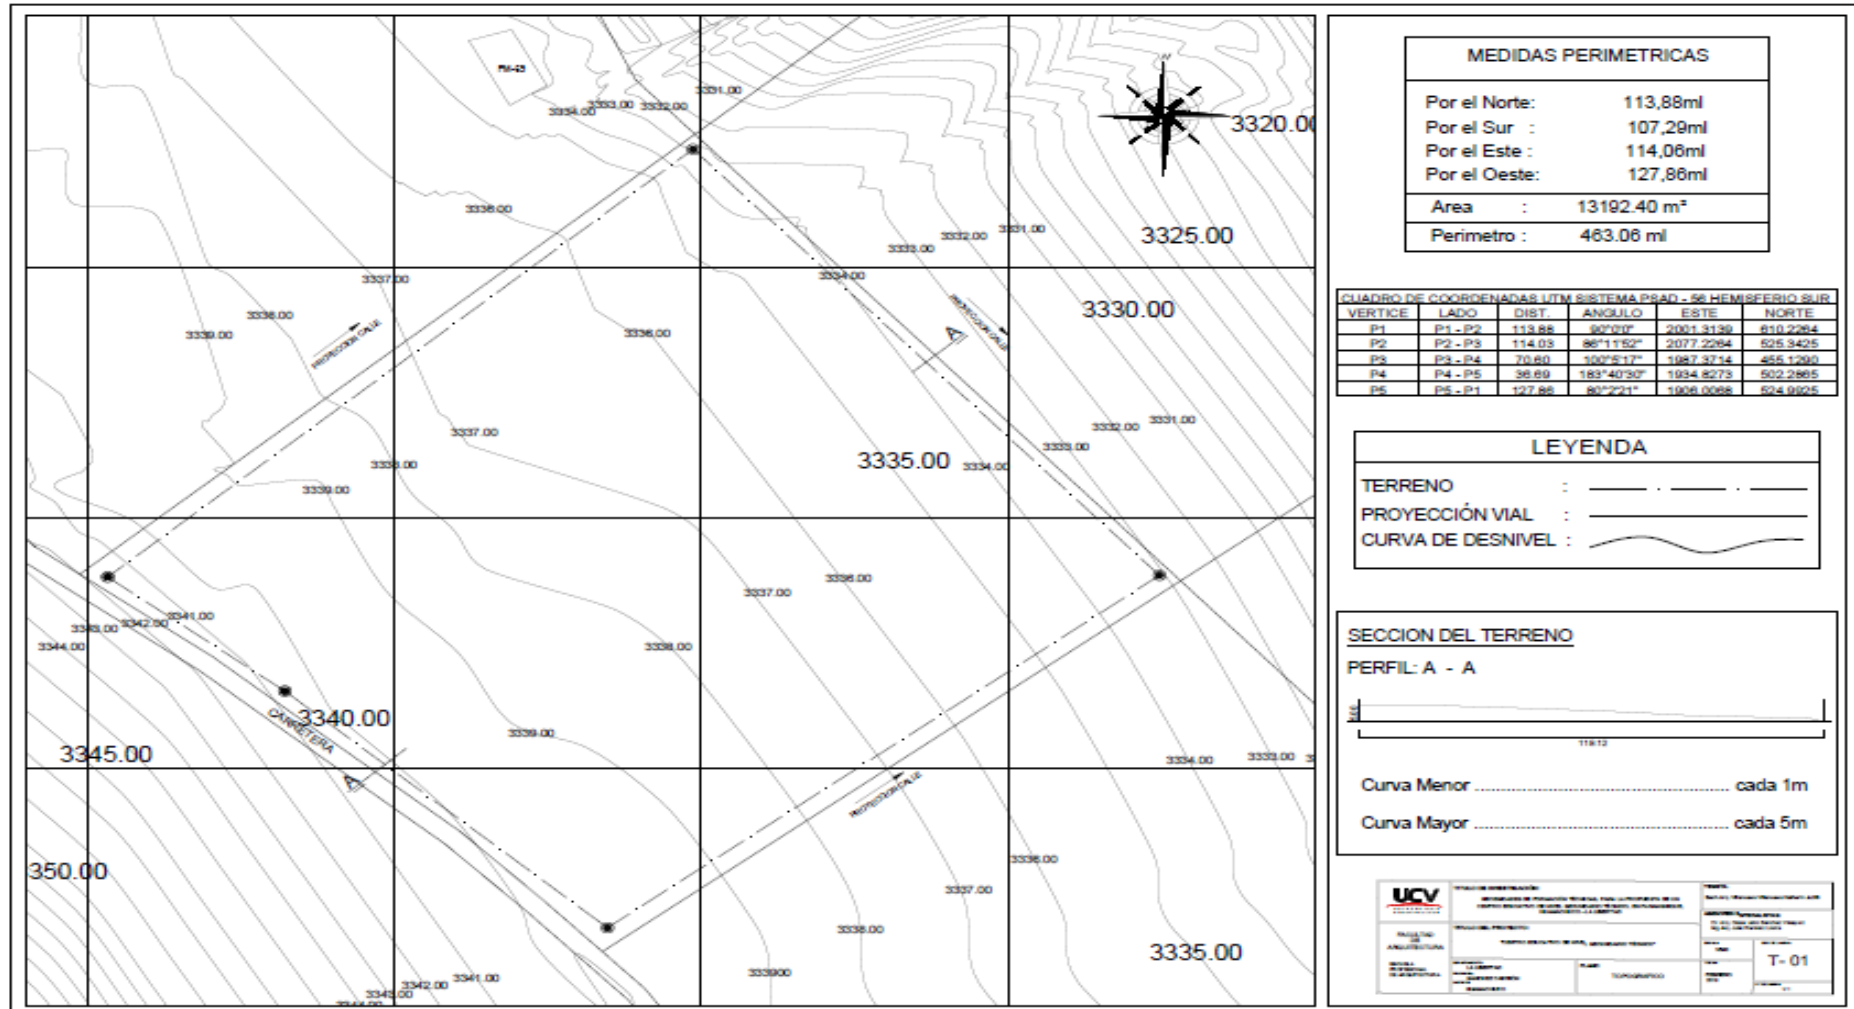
Plano de Topográfico – Plano N° 02 - Lamina T-01
